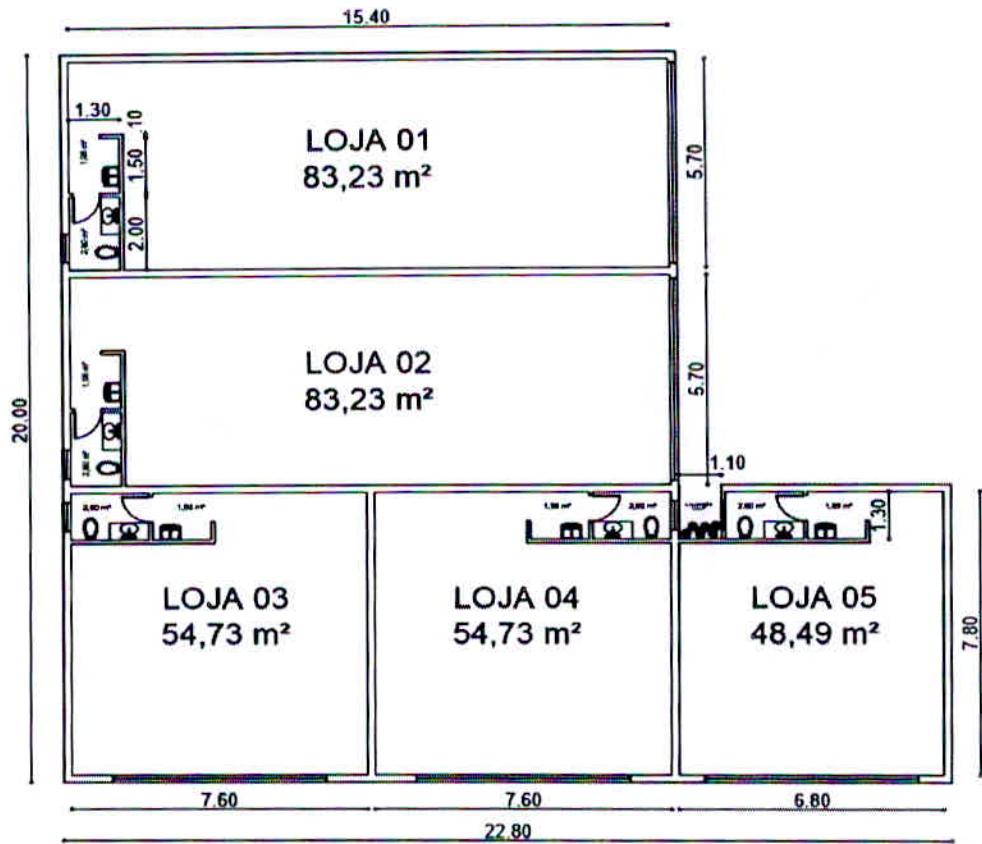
Projeto Arquitetônico do 1º pavimento – Projeto proposto.
